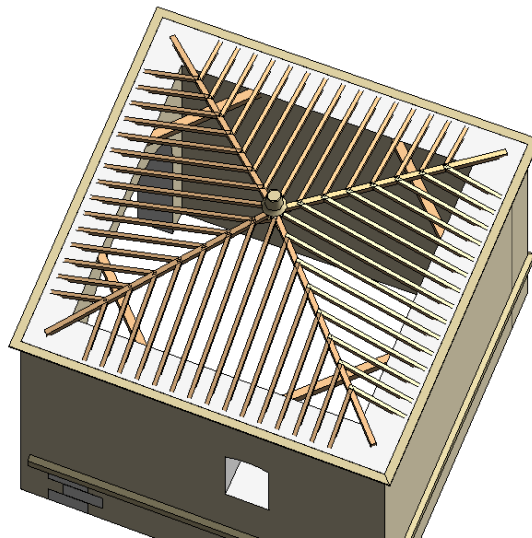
Modelado 3D de la estructura de madera, cubierta de la capilla. Fuente: elaboración propia
